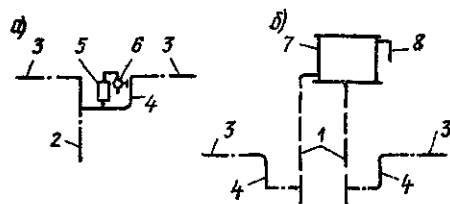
Схемы удаления воздушных скоплений из системы водяного отопления с нижней разводкой
